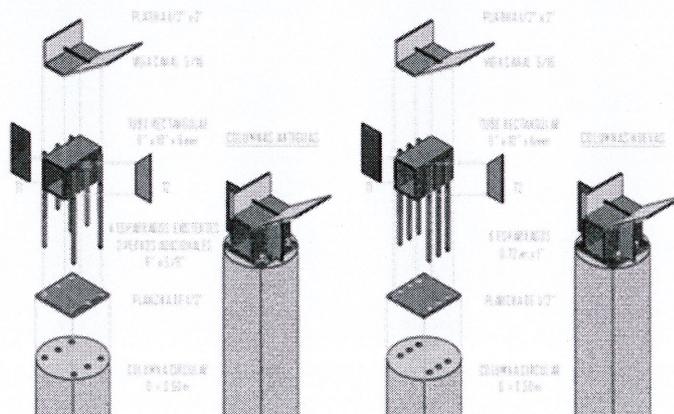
Detalle de anclaje entre columnas circulares y viga canal.
